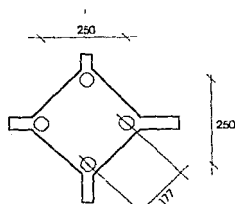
VISTA EN PLANTA DEL DADO D-2
